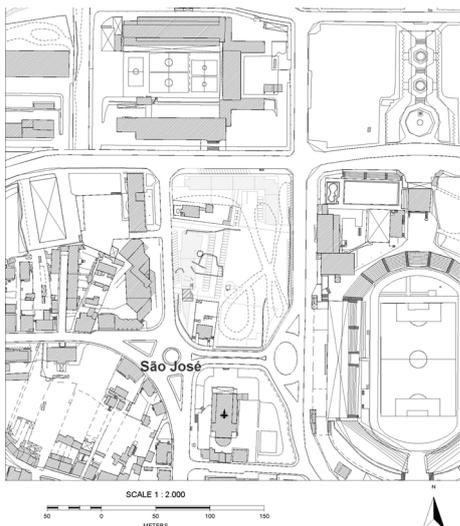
Planta Síntese de Loteamento da Urbanização Brotero (CMC; 2006).
